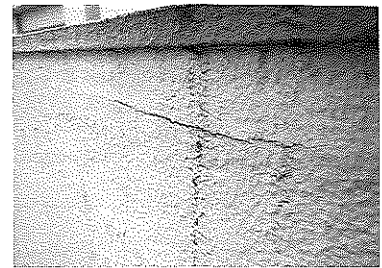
躯体ひび割れとつながる可能性がある、塗膜表面に現れたモルタルひび割れ
